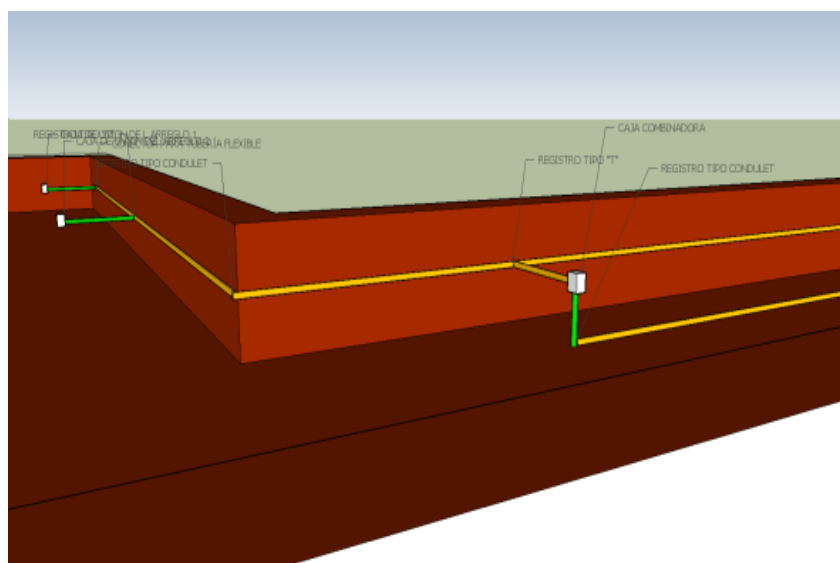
Plano 3D de Ruta de tubería, vista 2: aporte propio.
